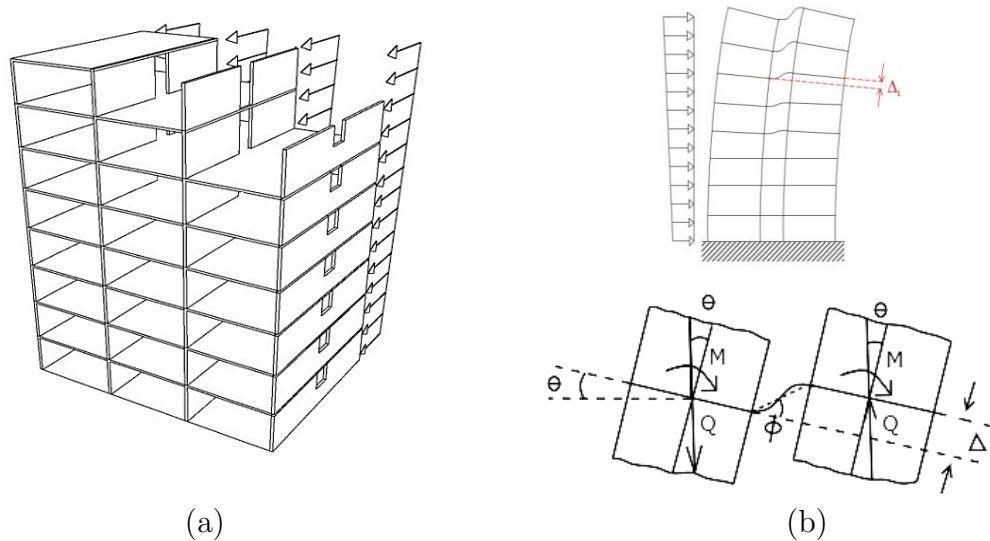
(a) Vista en perspectiva de una Estructura de Muros de Corte típica y (b) Respuesta del sistema sujeto a cargas laterales (basado en Schwaighofer y Collins, 1977)
